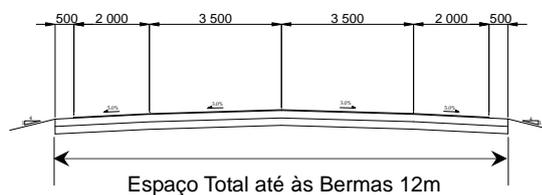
Concepção da Zona de Construção (Limitando a zona afectada)
